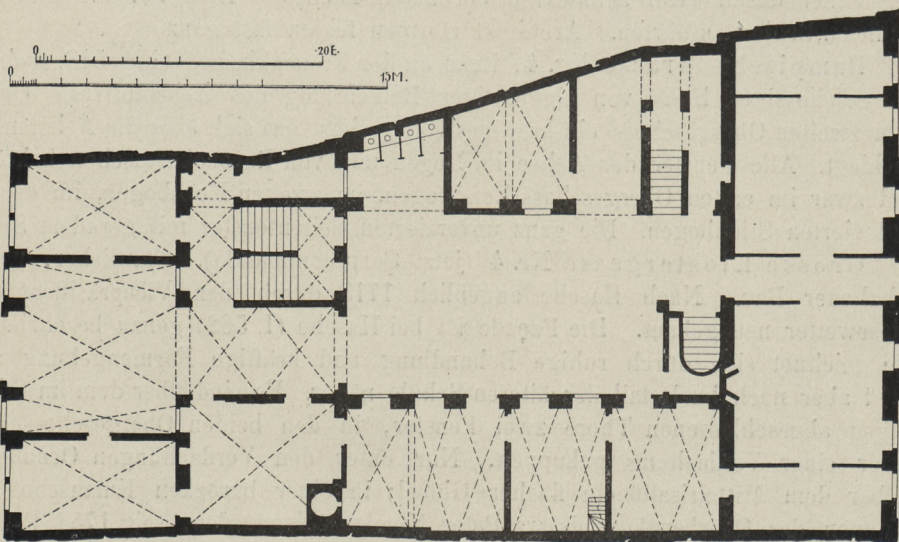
Klostergasse Nr. 4. Grundriss des Erdgeschosses.
